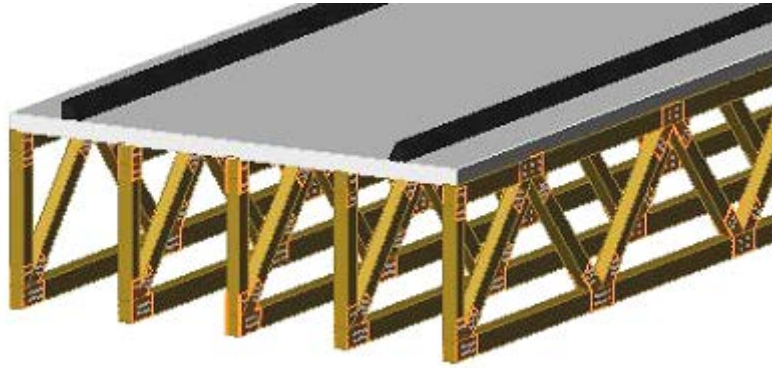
Схема композитного деревогрунтобетонного перекриття по дерев'яним фермам
